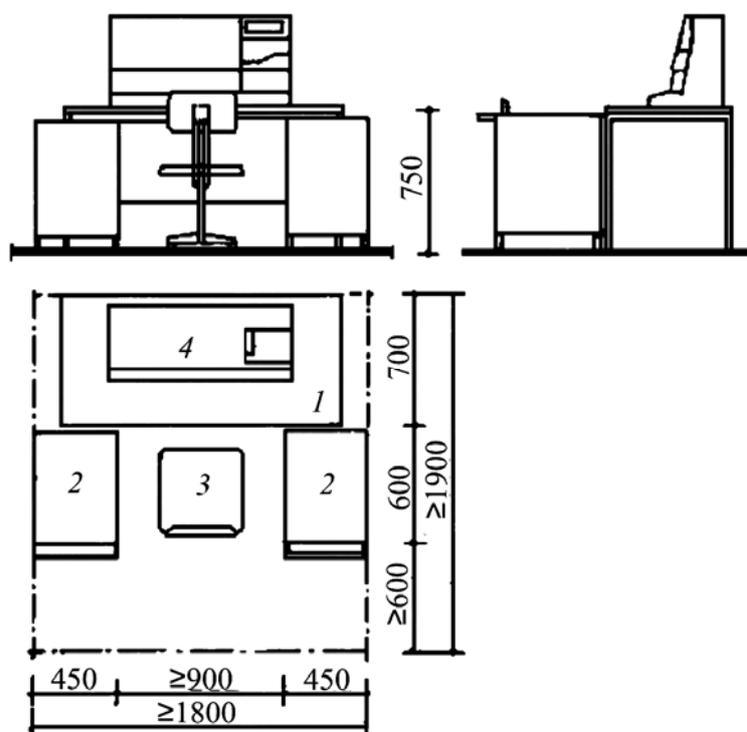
Рабочее место оператора машины для сортировки банкнот: 1 — стол рабочий; 2 — закрытая тележка (передвижной сейф) для транспортировки денег; 3 — стул подъемно-поворотный; 4 — машина для сортировки банкнот
